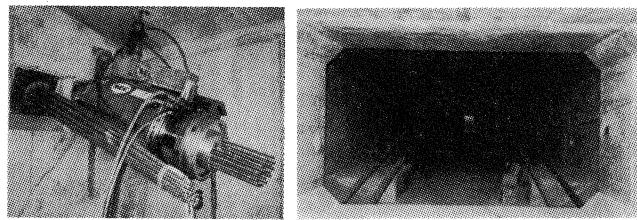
外ケーブル緊張ジャッキと外ケーブル配置
